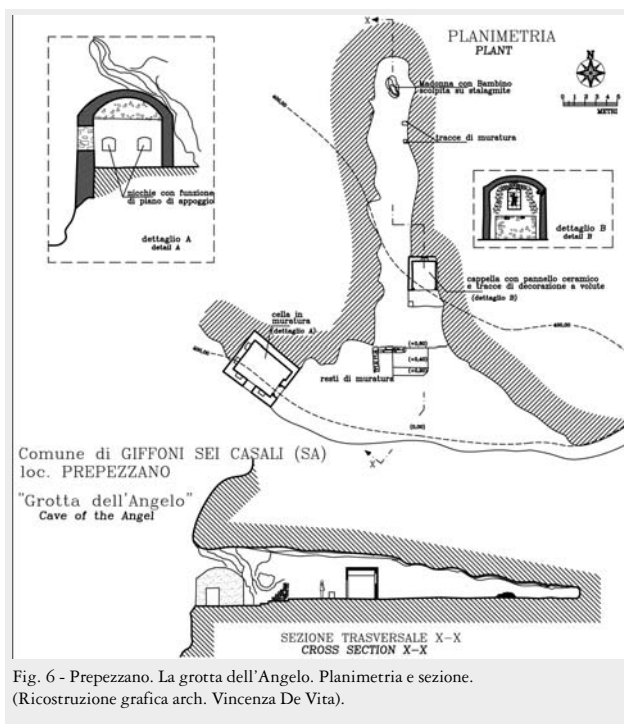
Prepezzano. La grotta dell'Angelo. Planimetria e sezione. (Ricostruzione grafica arch. Vincenza De Vita).
